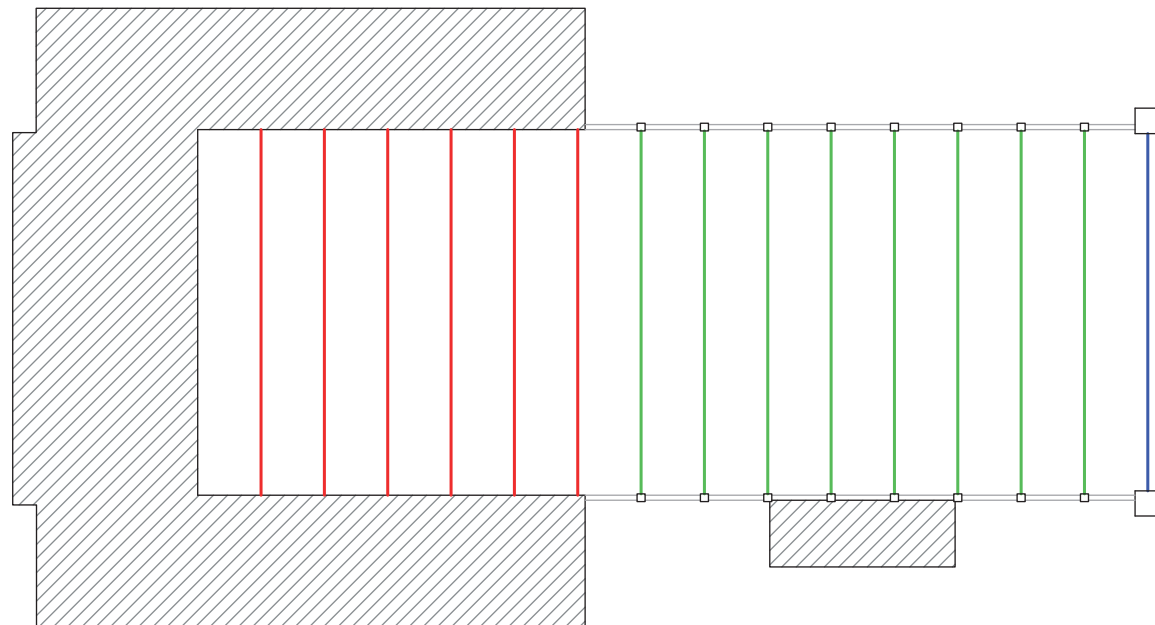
Detalle constructivo forjado planta primera edificio de viajeros
